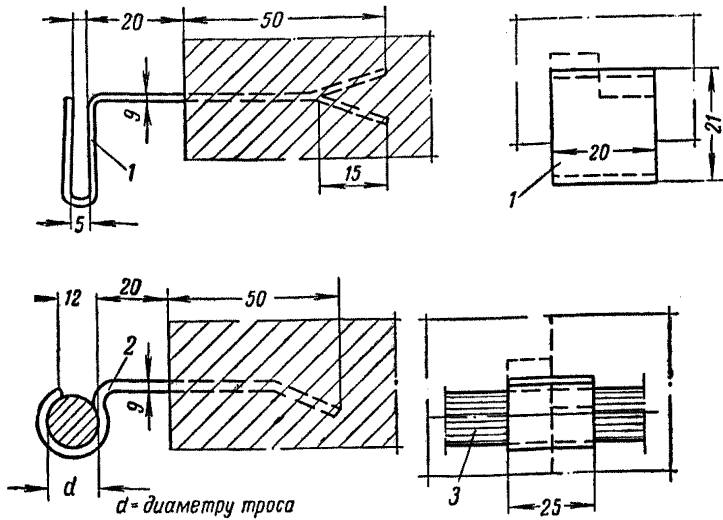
Крепление заземляющей магистрали в камере с бетонной крепью:
